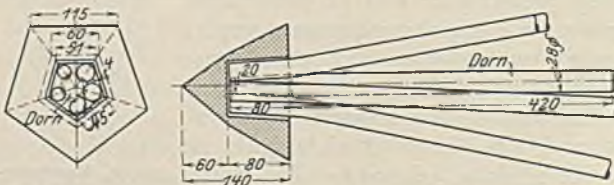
a u. 65 b. Ausbildung des Pfahlschuhes.
